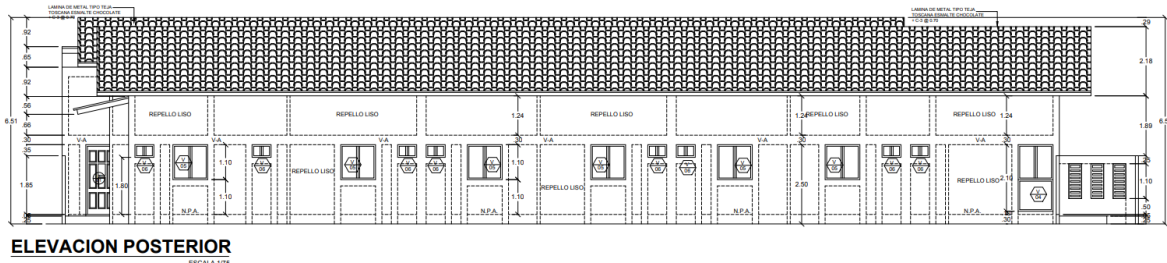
Elevación posterior. Fuente: plano de anteproyecto
